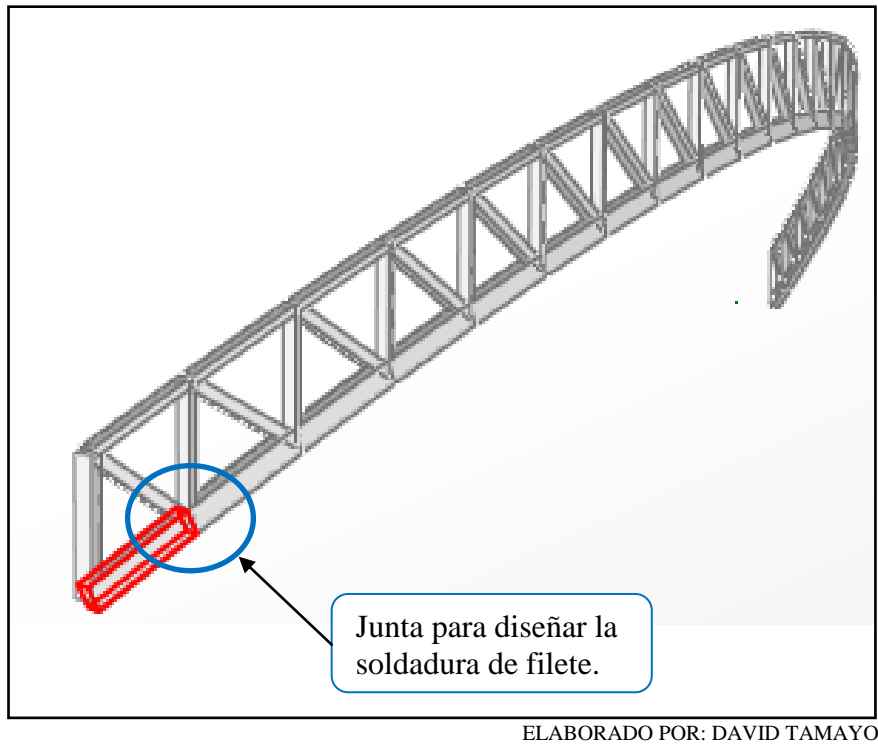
(Junta crítica para diseño de soldadura)
